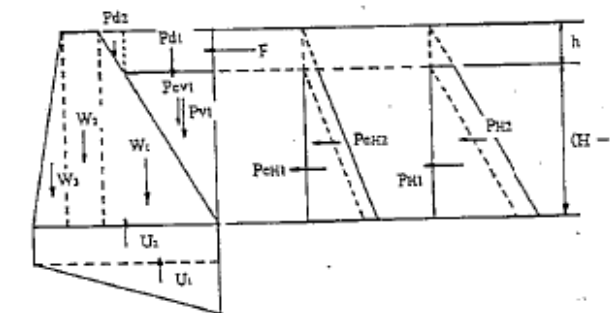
砂防ダムの単位幅当たり断面に作用する力(土石流時)
